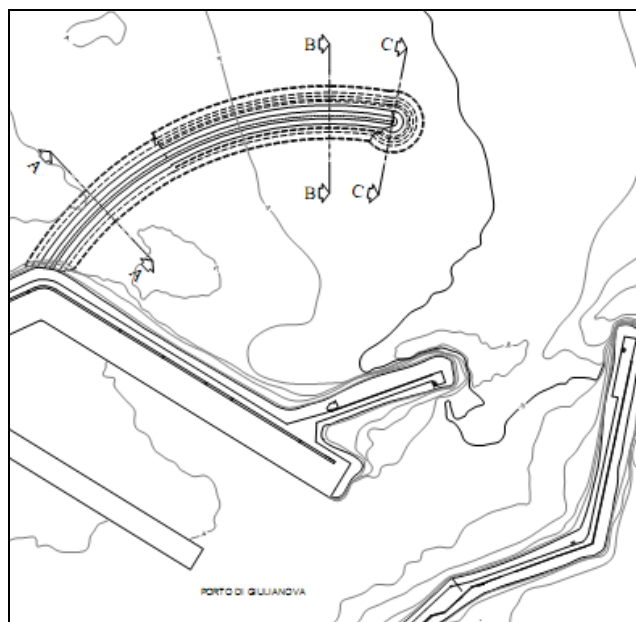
Planimetria della nuova Diga Nord del Primo Stralcio Funzionale con l'indicazione della posizione delle sezioni tipo.
